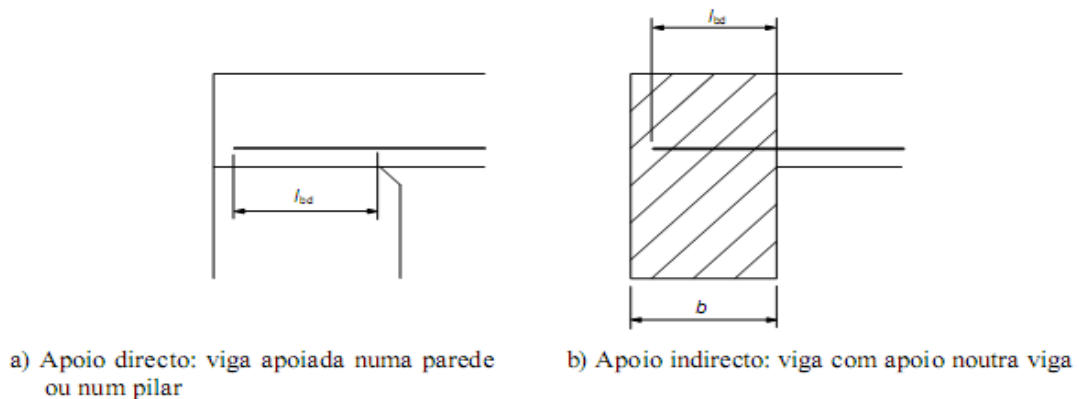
Amarração das armaduras inferiores sobre apoios de extremidade
